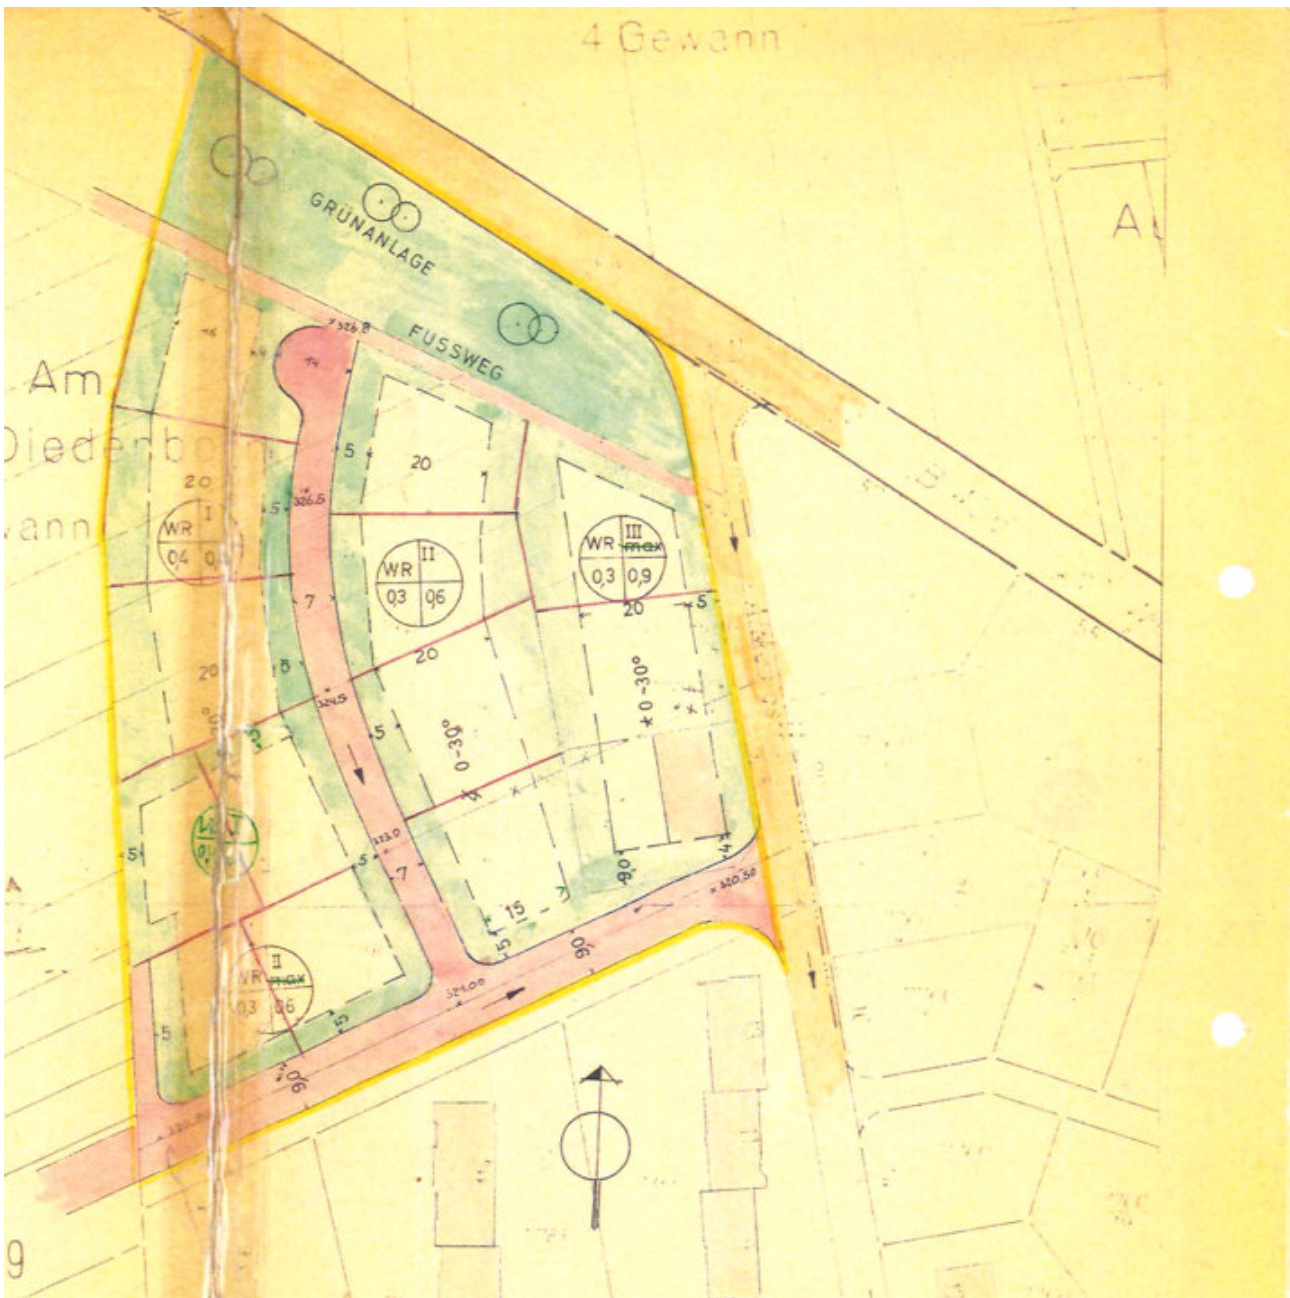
bisheriger Bebauungsplan, nur Planzeichnung
